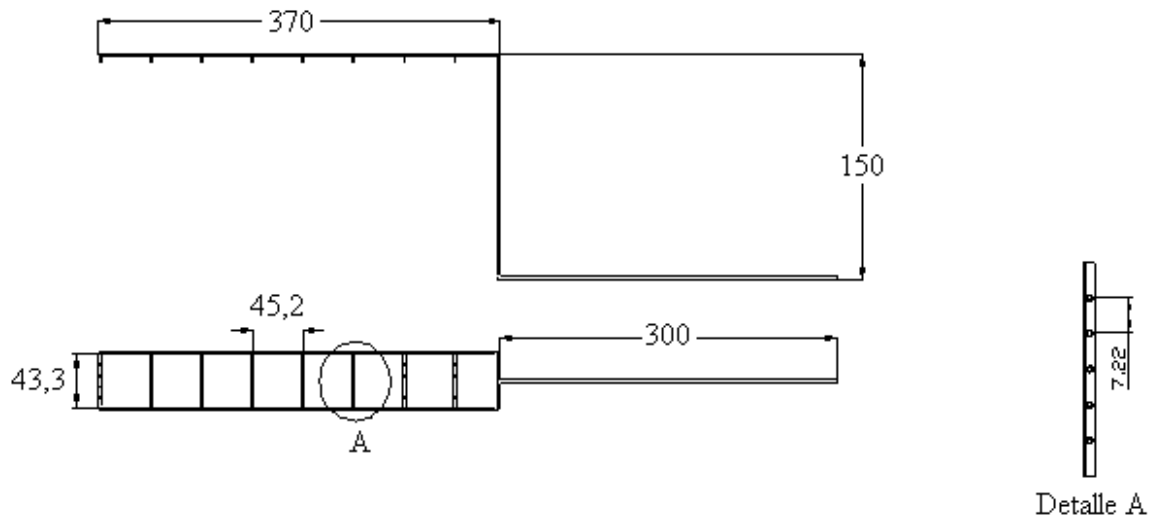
Detalle de Tuberías de agua. (Medidas en cm). Fuente. Propia.
